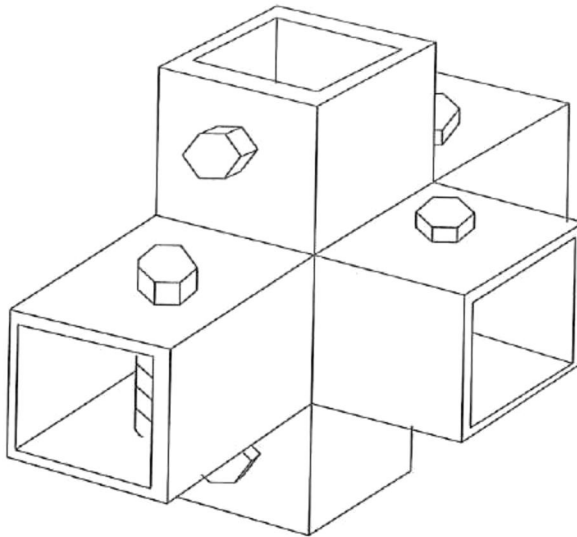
Conexión para viga y columna exterior de pisos intermedios.
